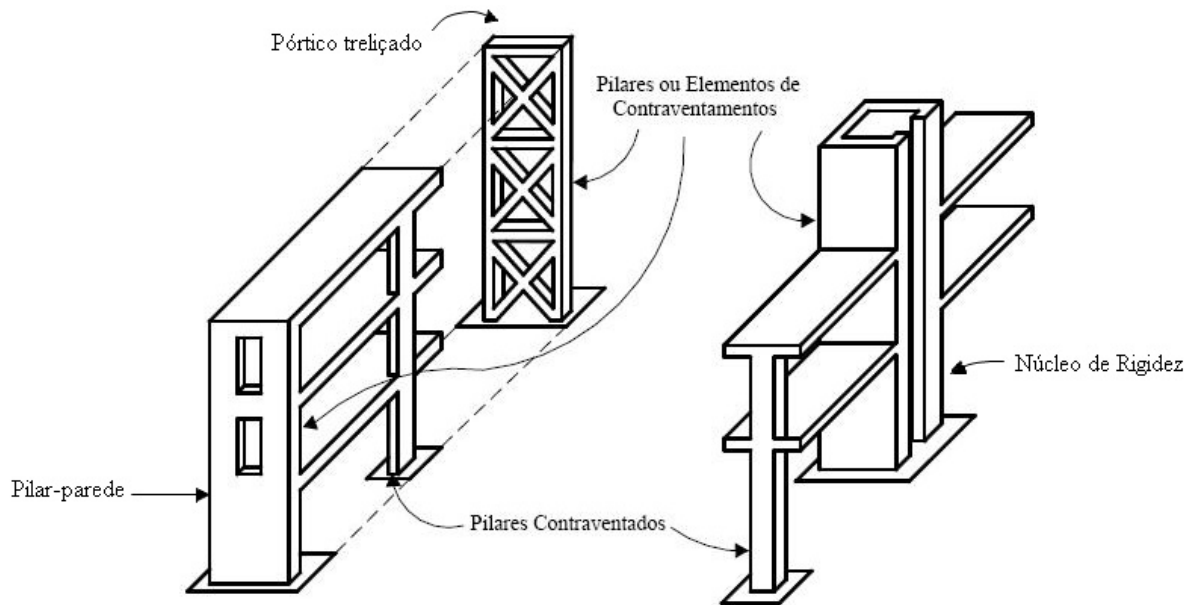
Pilares contraventados e elementos de contraventamento (FUSCO, 1981).
